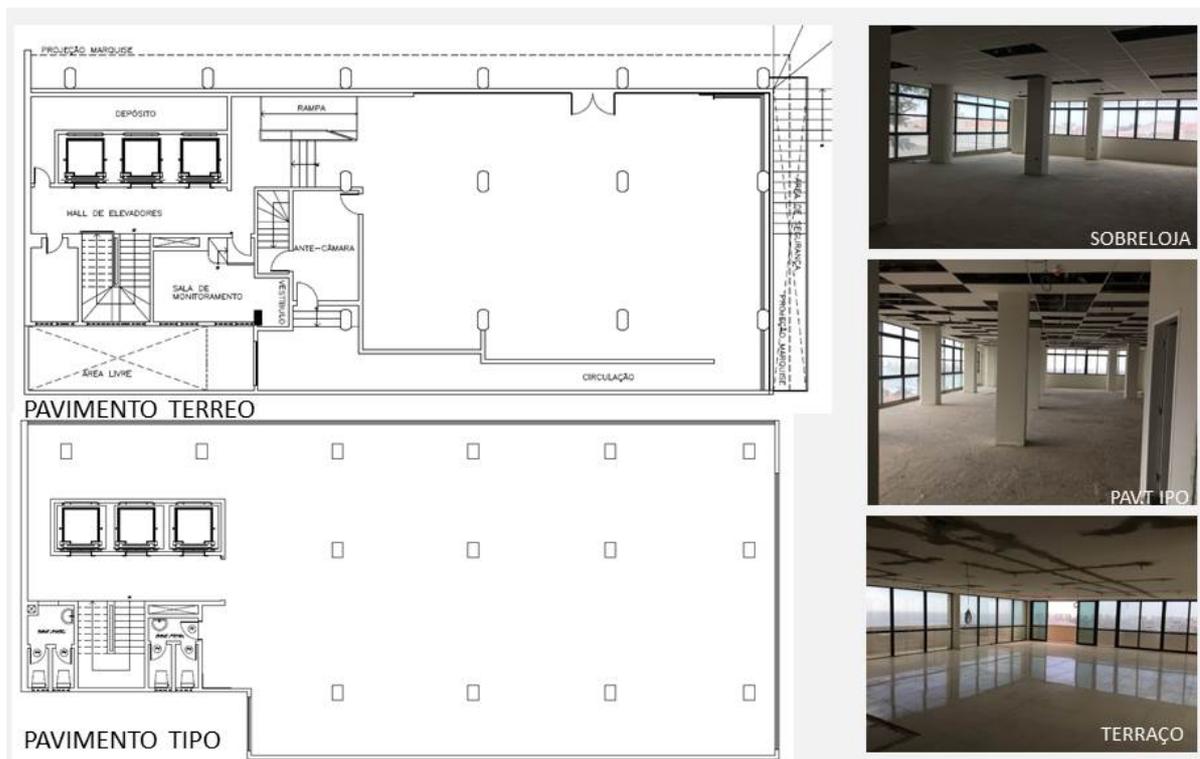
Plantas do pavimento térreo e pavimento tipo original e vistas da Sobreloja, Pavimento tipo e Terraço. Fonte: Arquivos Arquiteta Andrea Duailibe (plantas) e Lúcia Nascimento, 2017.
